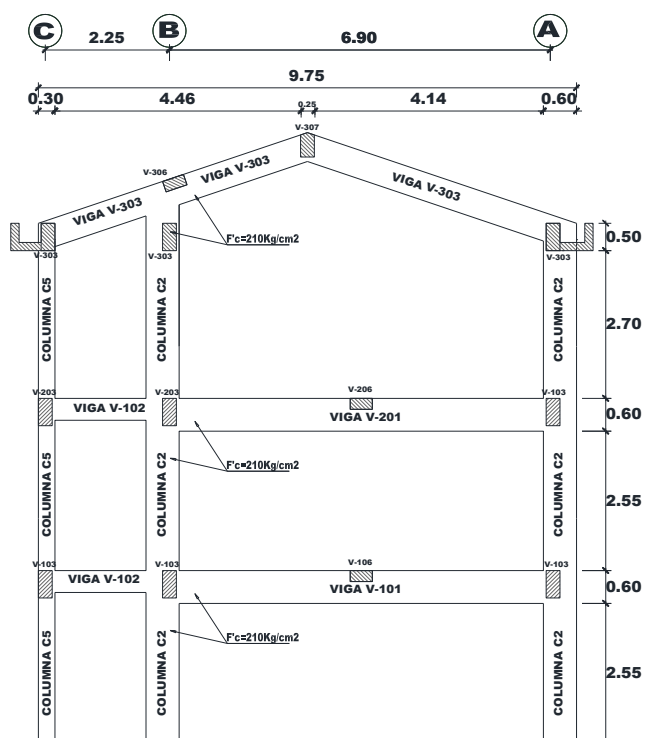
Pórticos en elevación de los ejes 2,4 y 6.
